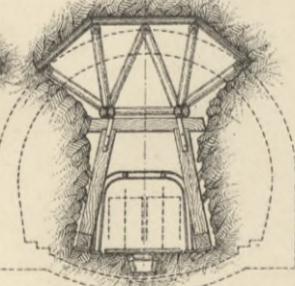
Ender Tunnel. (1876-1878). Bauart Merme.
